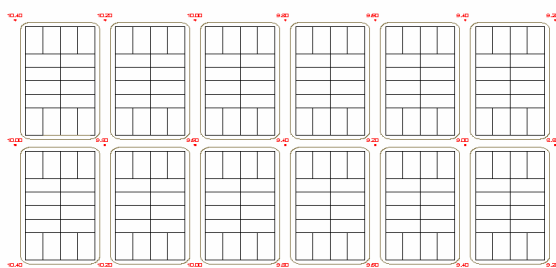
Planialtimetría del Barrio de Viviendas a Modelar
